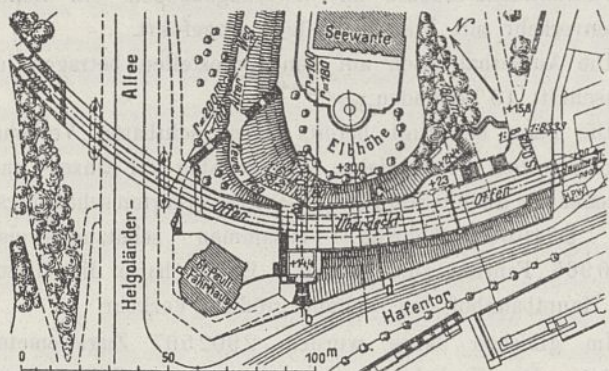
Lageplan. Haltestelle Landungsbrücken.
